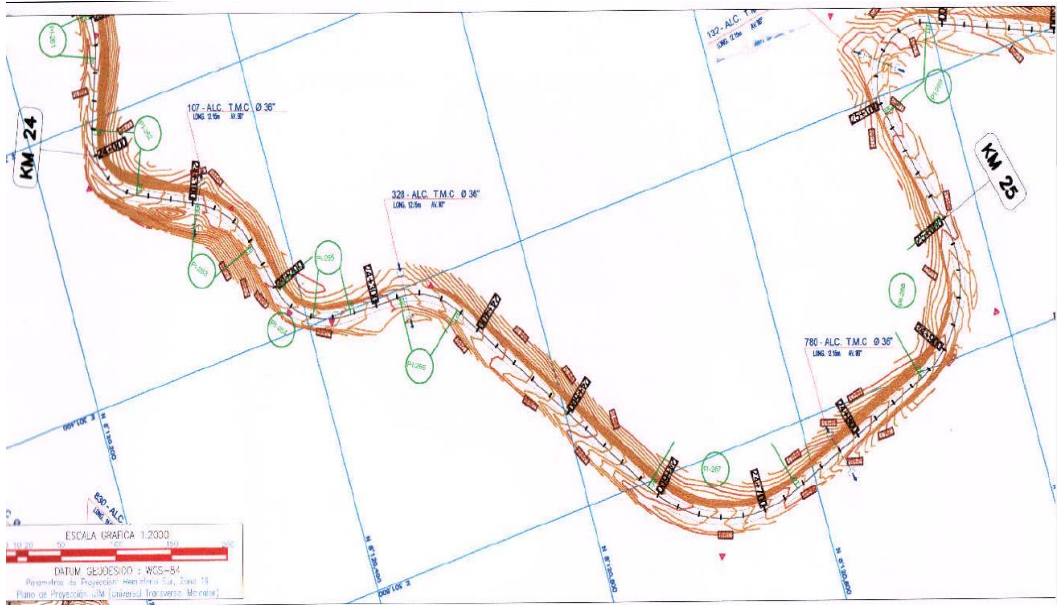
Plano de Planta tramo Km. 24+000 al Km 25+000
